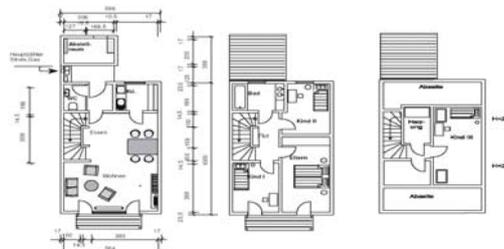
Gebäudegrundriß der Reihenmittelhäuser
